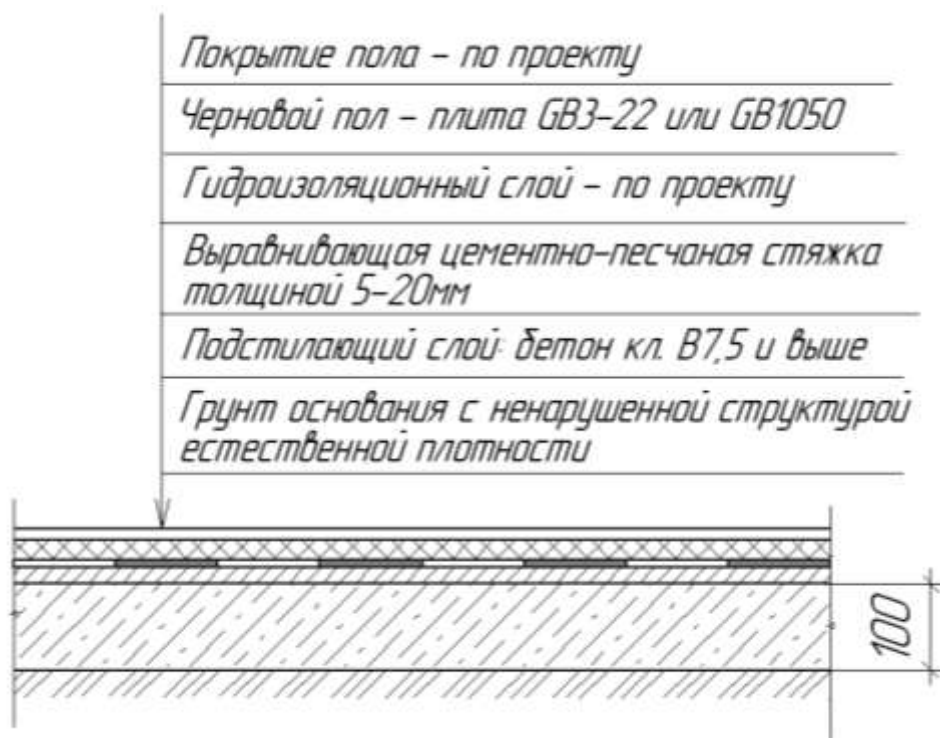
Конструкция монолитного пола по грунту с применением системы плит GREEN BOARD® без утепления на подстилающем бетонном слое с выравнивающей стяжкой
